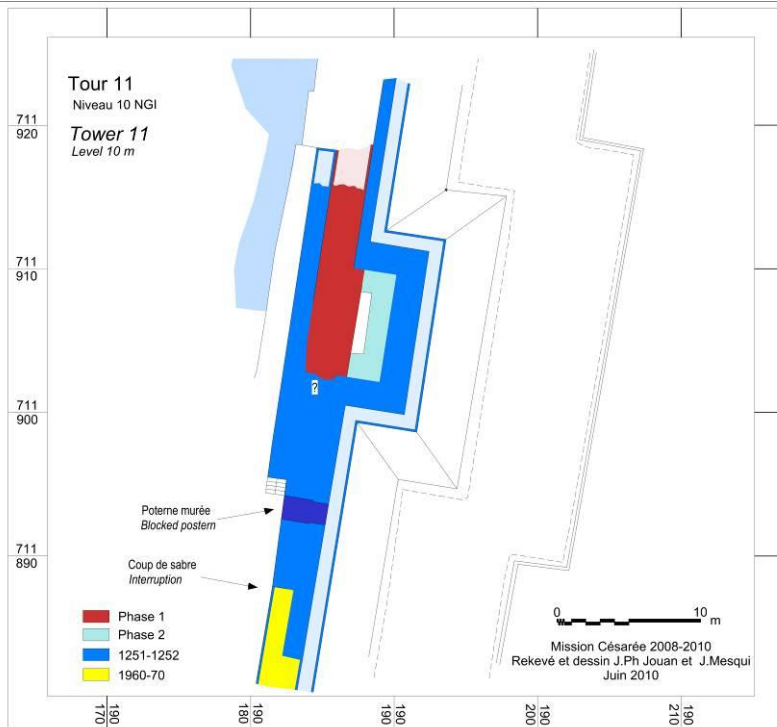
Plan de la tour T11 au niveau 10 m ASL
